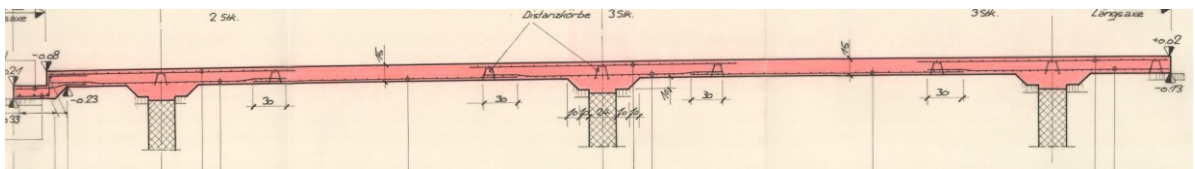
Schnitt bestehende Foundation der 400 m Rundbahn
